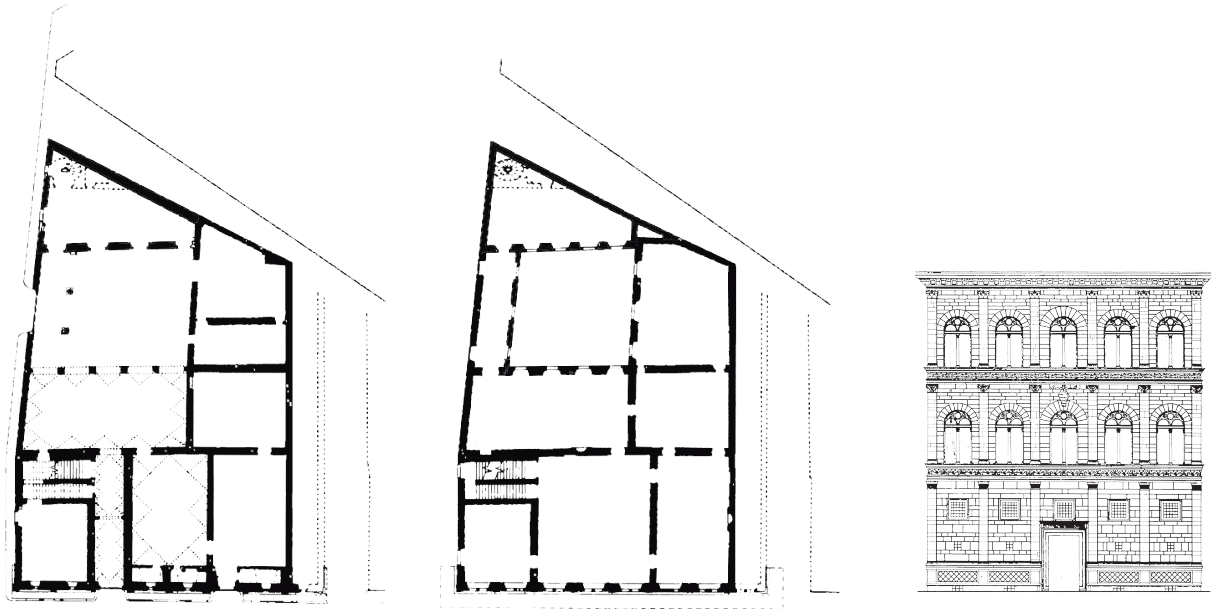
Palacio Rucellai, Florencia, Siglo XV - Planta baja, Planta primera y Alzado
